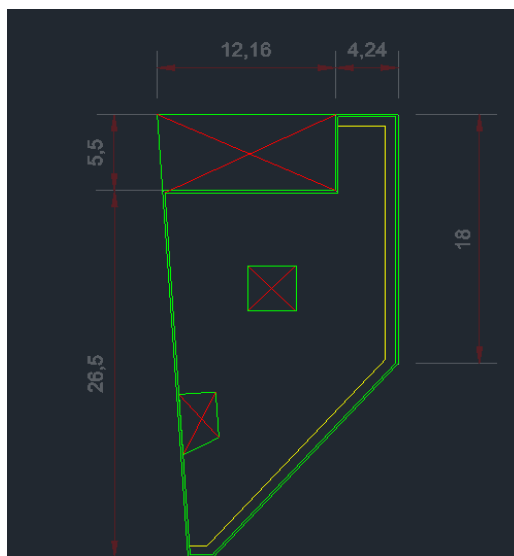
Vista de planta de l'edifici. Font:Carolina Porta.
